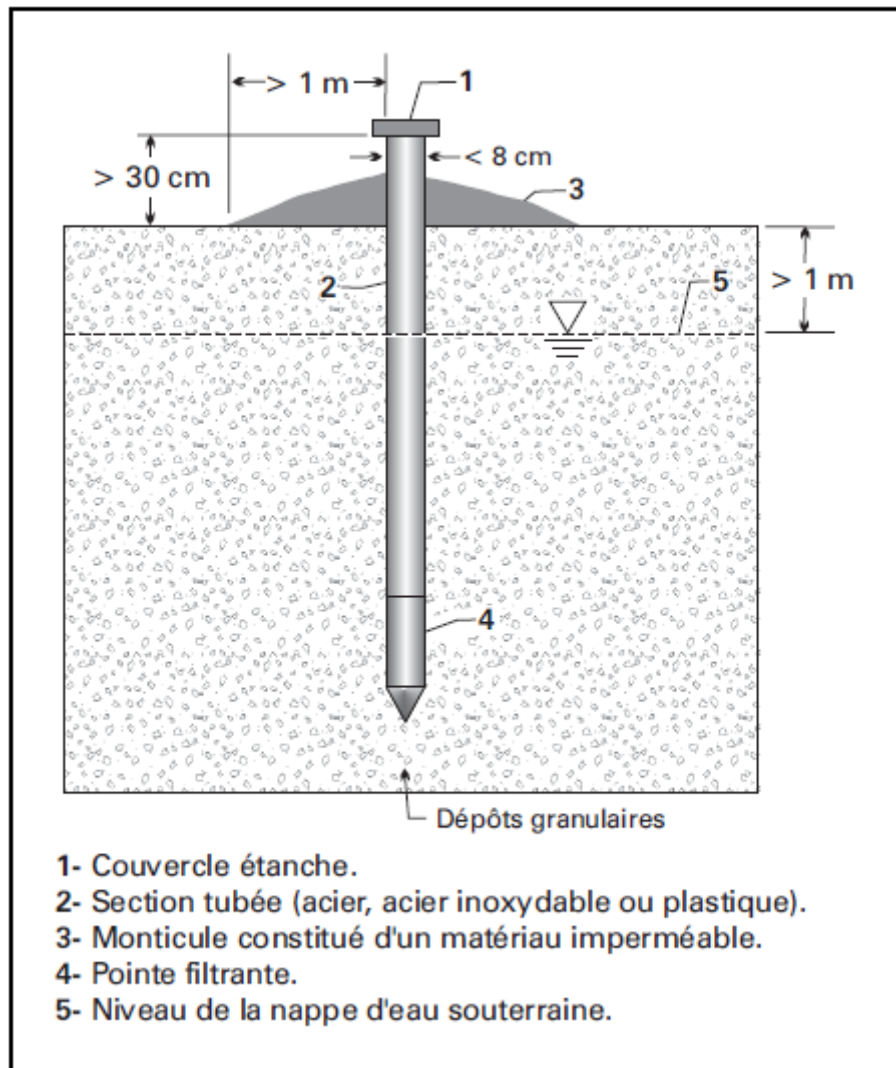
Schéma d'aménagement d'une pointe filtrante
